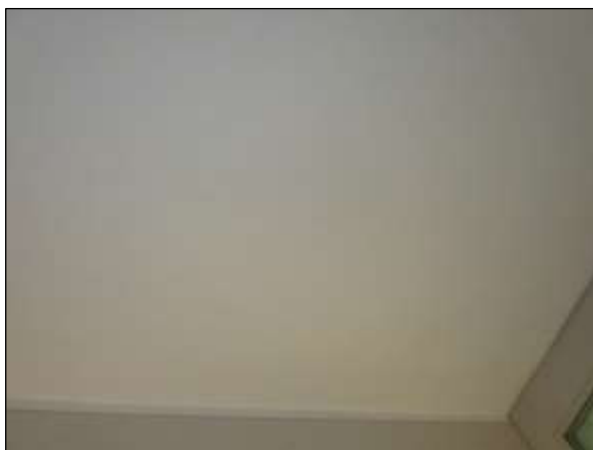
Porzione del plafone del Disimpegno 2 al primo piano connotata da un eccessivo distacco della finitura.
